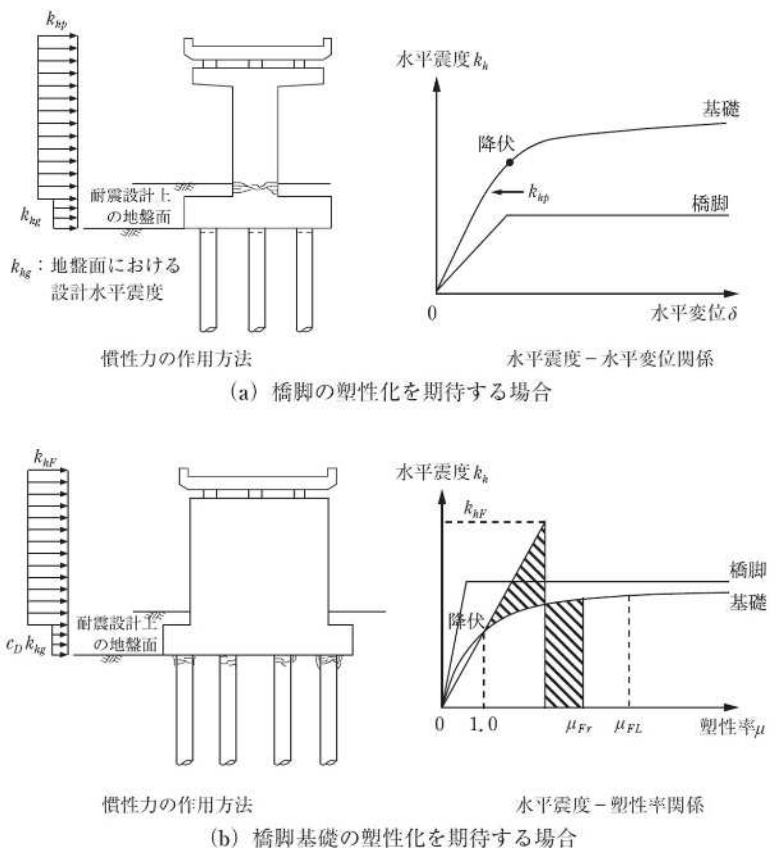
橋脚基礎の設計の概念図（道示V図-解 10.2.1）
